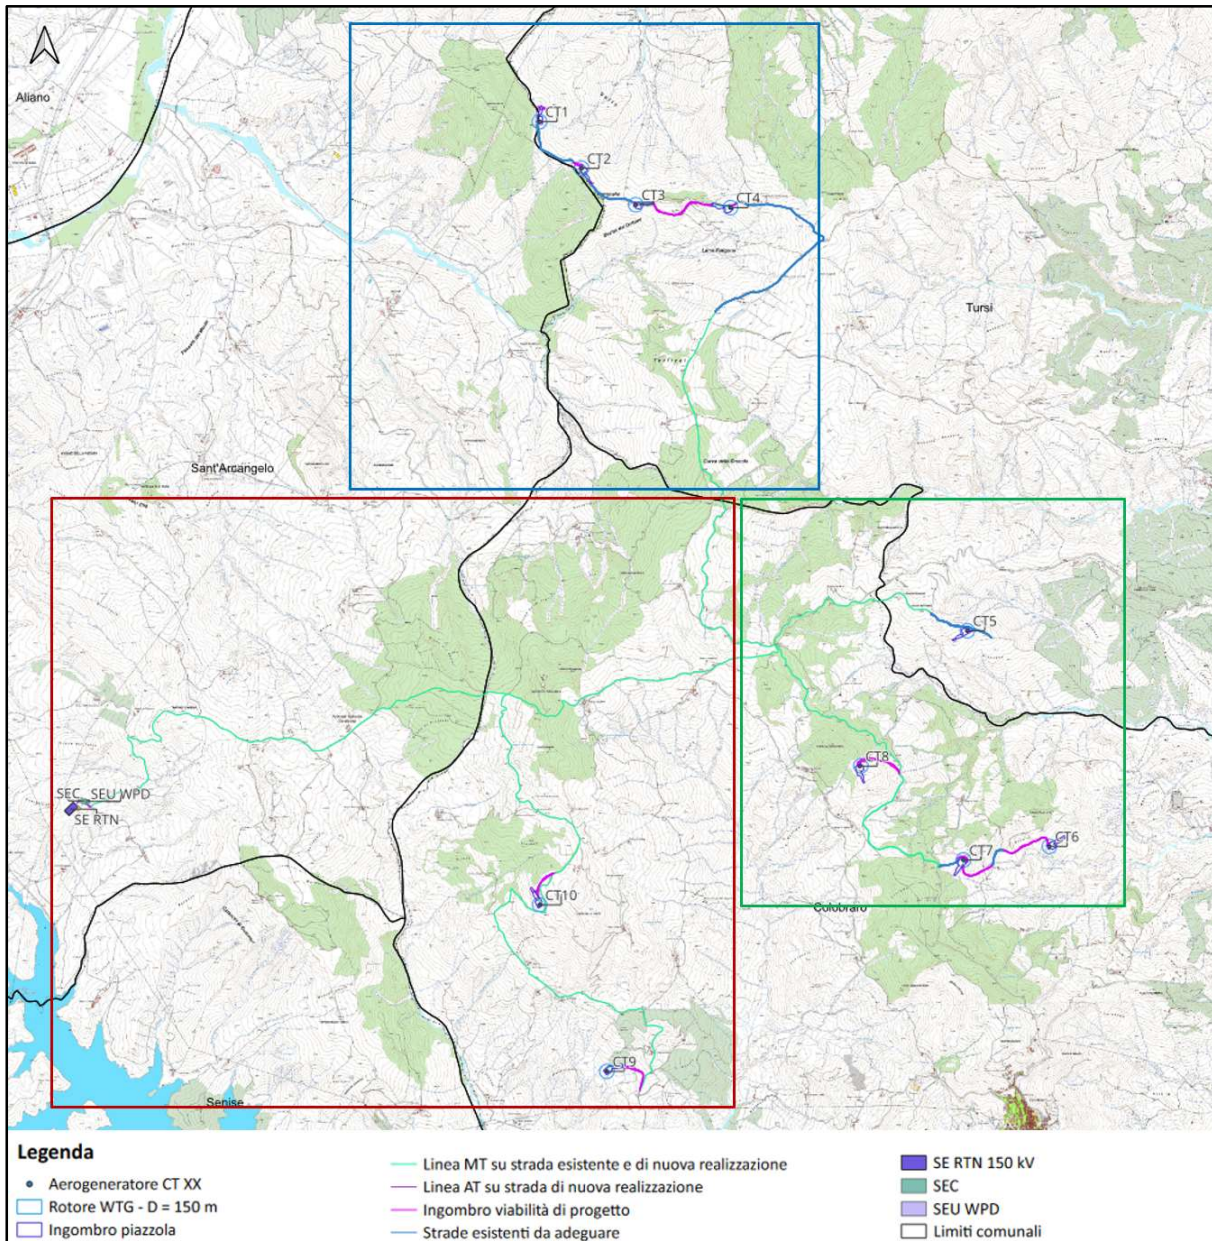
Layout d’impianto suddiviso in zone su CTR: Zona 1 - rettangolo rosso, Zona 2 - rettangolo azzurro, Zona 3 - rettangolo verde
